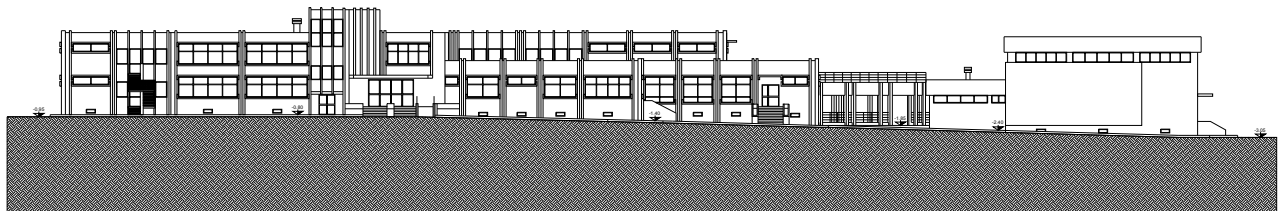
Prospetto Sud-Ovest dell'Edificio
